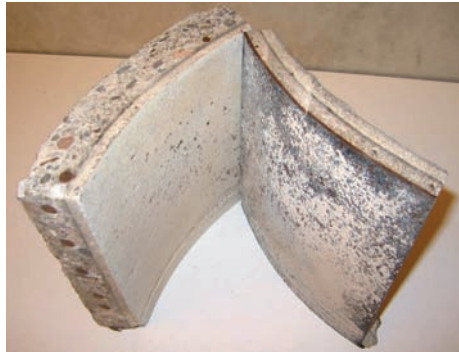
Falta de adherencia entre la chapa y el hormigón/Picture 5. Lack of adherence between the steel plate and the concrete.
